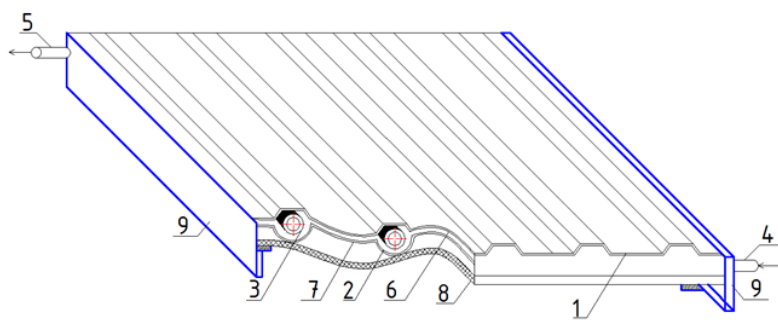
Схема геліопокрівлі: 1 – верхнє гофроване покриття; 2 – нижнє гофроване покриття; 3 – трубки контуру циркуляції; 4 – вхідний патрубок; 5 – вихідний патрубок; 6 – шар селективного матеріалу; 7 – дзеркальний шар; 8 – теплоізоляційний шар; 9 – кроквя
